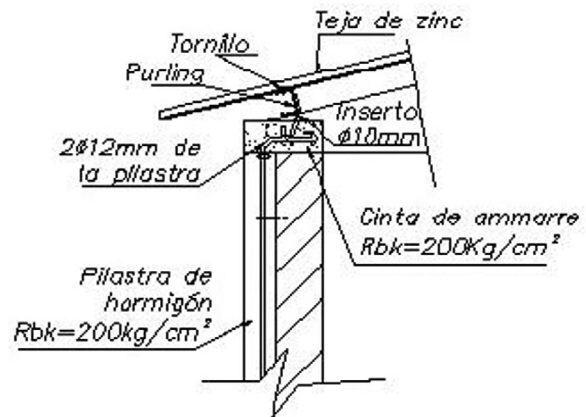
VISTA EN CORTE DE PILASTRA ADOSADA CON DETALLE DE UNIÓN A CINTA DE AMARRE.
